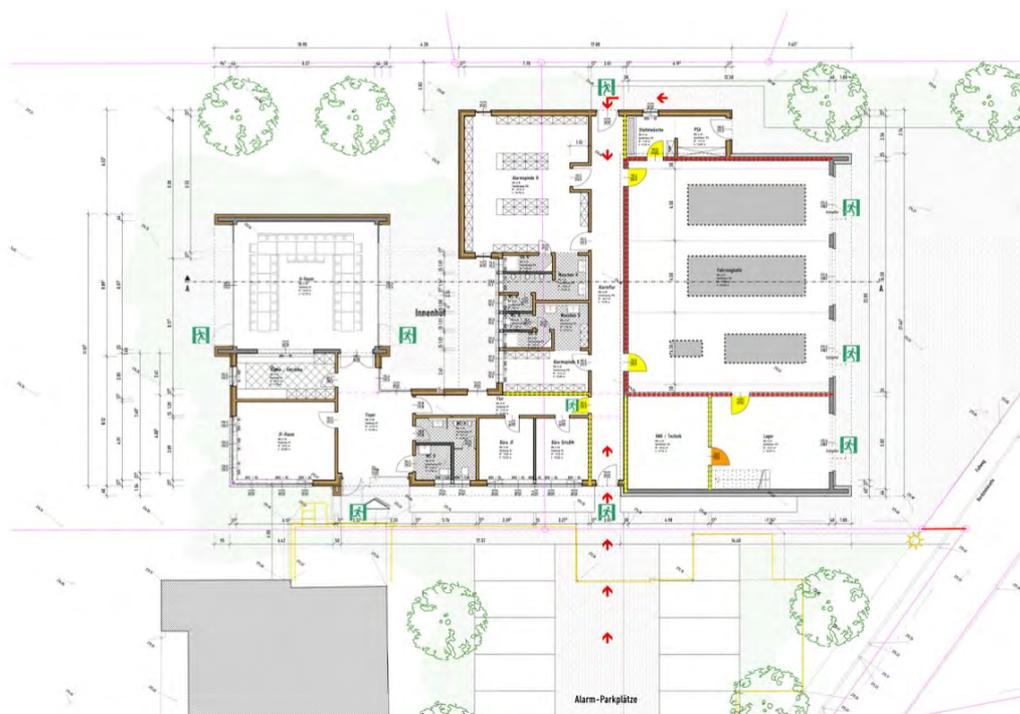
Grundriss EG des FH Hagen (Quelle: Architekt M. Kuhn)
